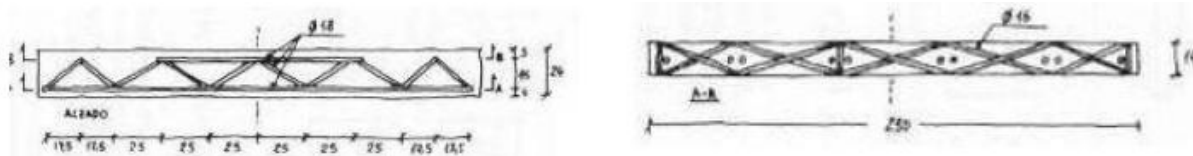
Alçado e planta da utilização de treliça com barras de fibra de vidro (Cigni;1981).
